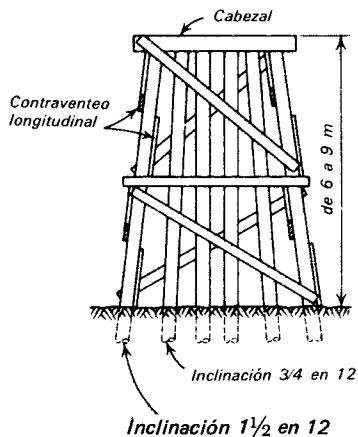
Uso de pilotes inclinados en el caballete de un puente.
